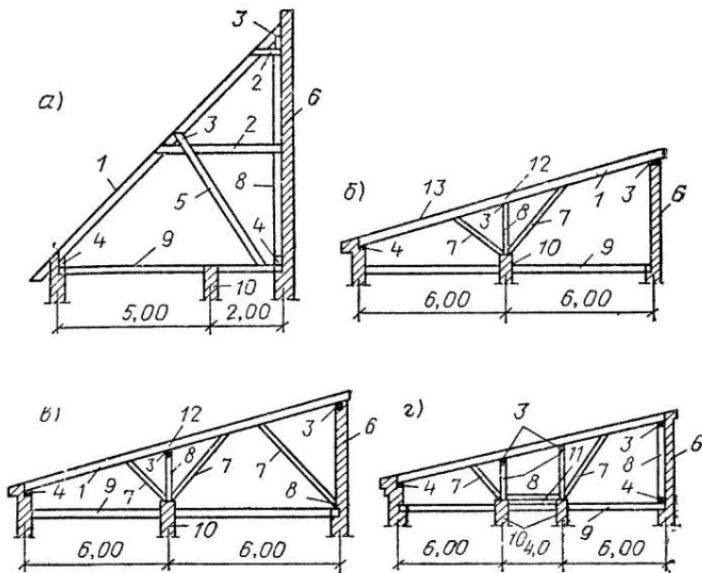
Односкатные крыши с опорными стойками и подкосами у зданий, имеющих одну или две капитальные стены
